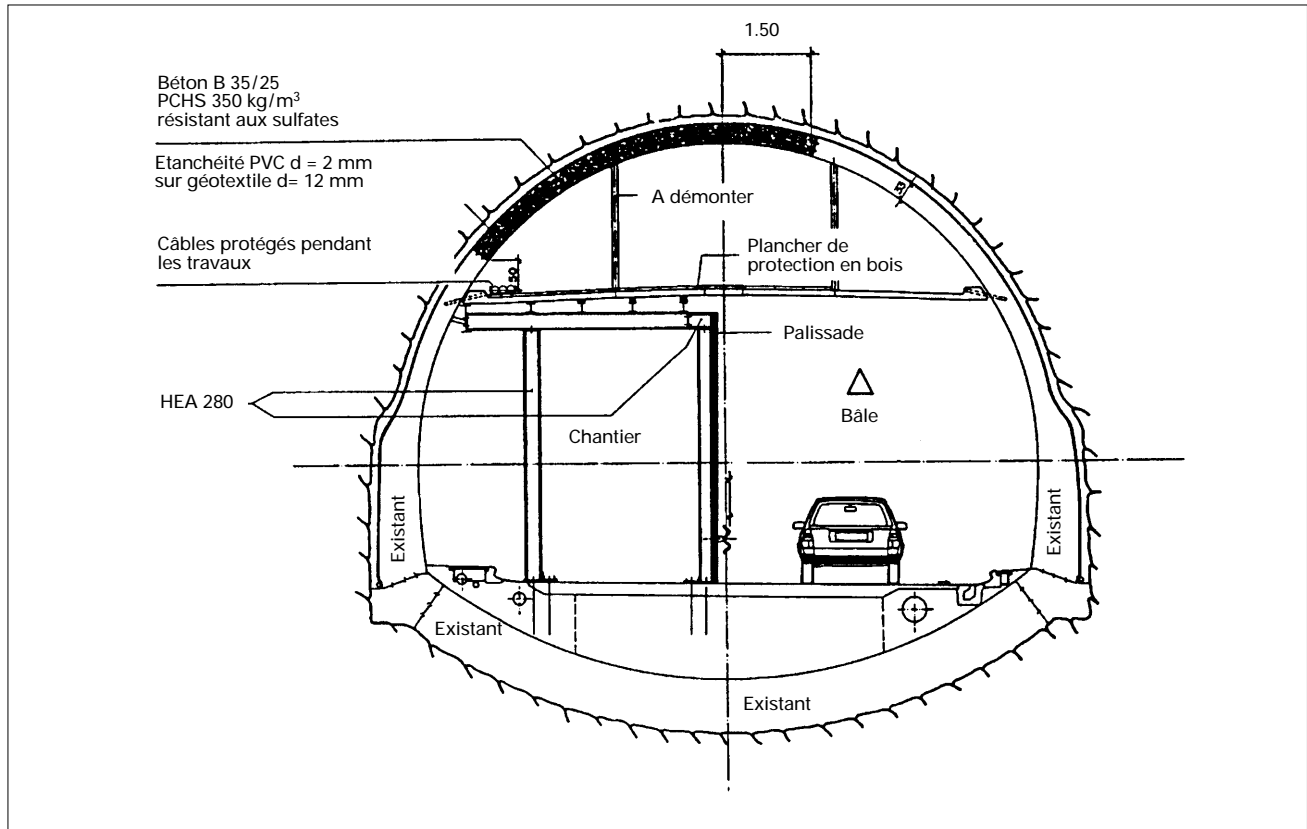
Profil du tunnel avec soutènement provisoire de la dalle intermédiaire. La voûte endommagée a été remise en état sur la longueur de l'élément, sur 6 m de large
